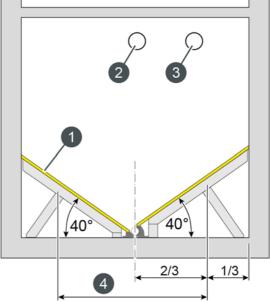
Construction du plancher incliné pour la vis d'extraction
